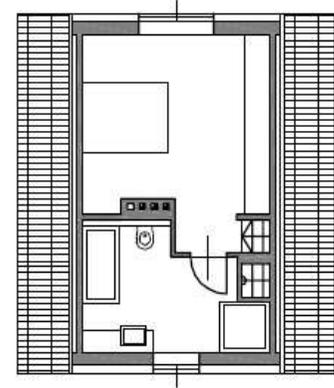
Variante I - Grundrisse⁸⁴
